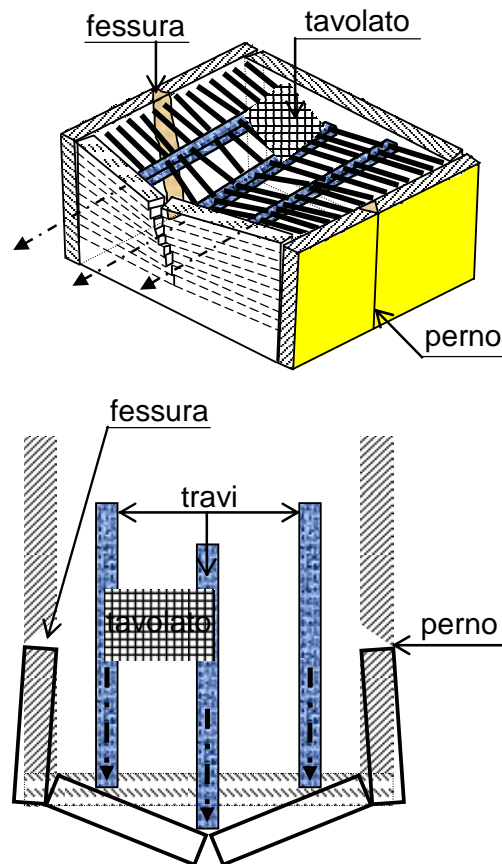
d. Le due figure tratteggiano il classico meccanismo che detta la portanza del muro per un'azione fuori dal piano, disegnato per il caso $c/1^{\circ}$: in tridimensionale a sinistra; in pianta a destra. La figura illustra il meccanismo più oneroso per il muro. La trave spinge il muro d'appoggio da un lato (e perde l'appoggio del muro dall'altro lato), in conseguenza della forza sismica orizzontale di piano. La spinta delle travi fuori dal piano, unitamente all'inerzia del muro stesso, determinano il ribaltamento di tale muro porta-solaio (mentre l'altro muro porta-solaio può preservare la verticalità).
